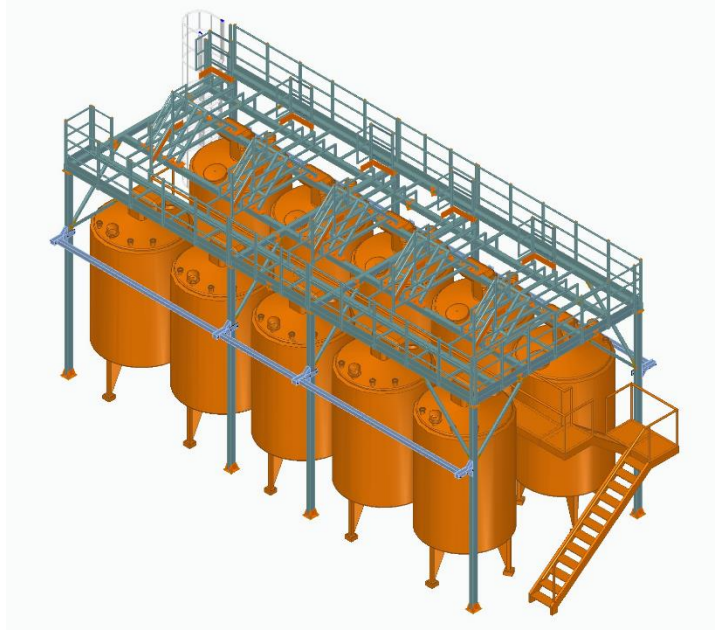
Vista struttura posta nella zona stoccaggio creme bianche (Solid Edge) con messa in evidenza degli irrigidimenti laterali modificati
